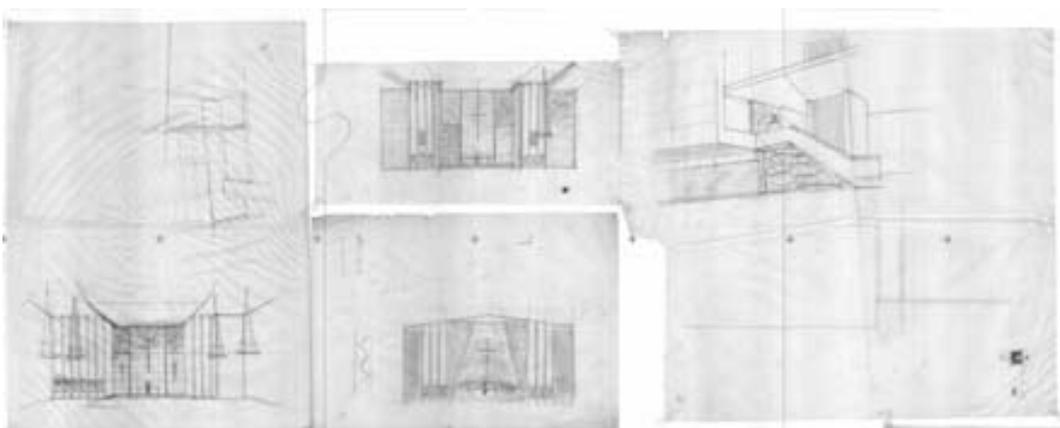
Croquis do arquiteto. Fonte: Acevo FAM.
